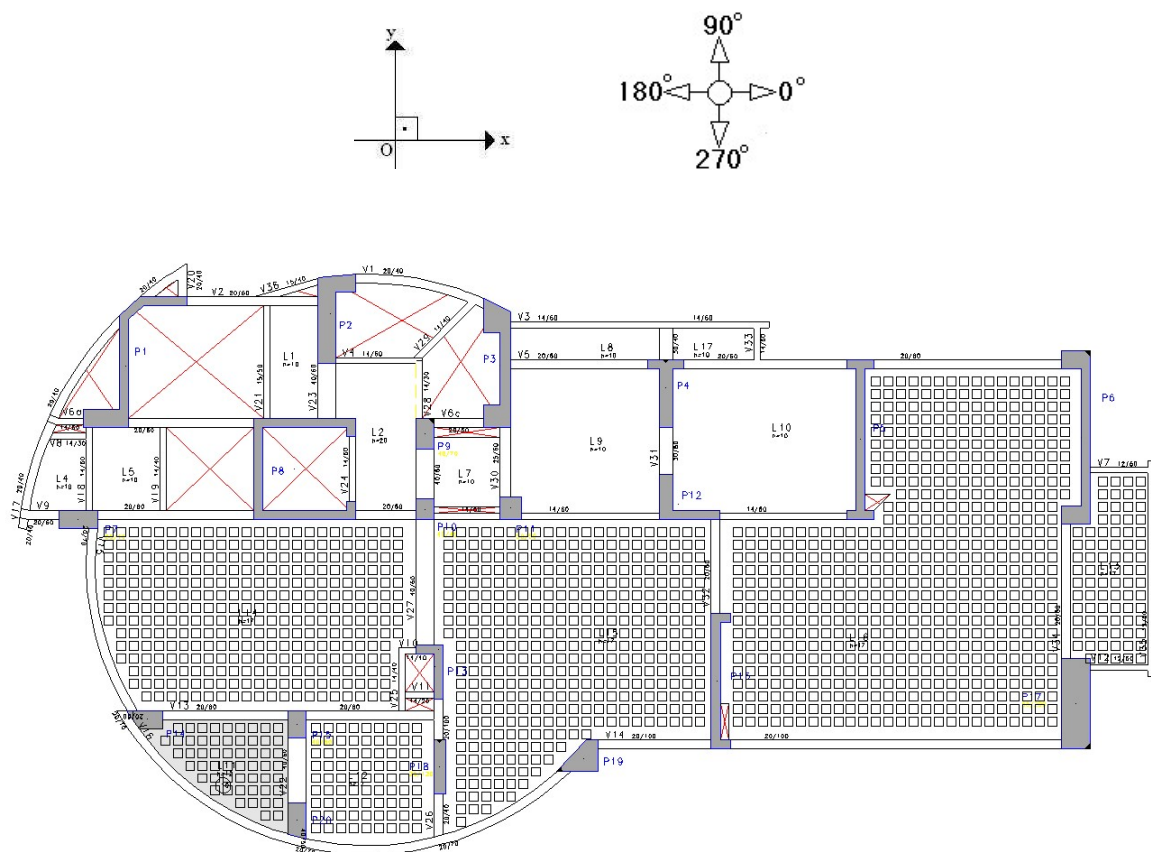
Forma da estrutura pavimento tipo, modelo 1.
